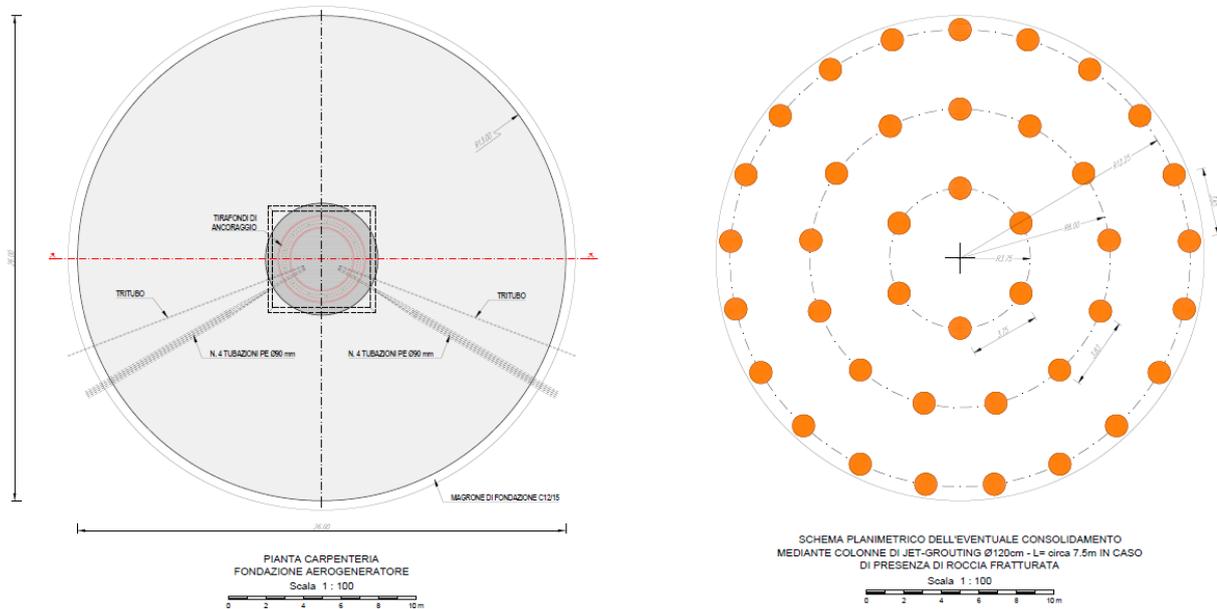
Schema tipo della fondazione dell’aerogeneratore ed eventuali consolidamento del terreno con colonne di jet-grouting.
